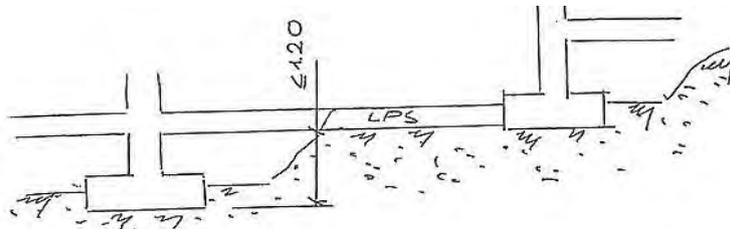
Liaison des semelles situées sur des niveaux différents. Des longrines sont nécessaires si la différence de hauteur d'implantation est inférieure à la limite autorisée. (Document JM Perrissol pour EAML)
